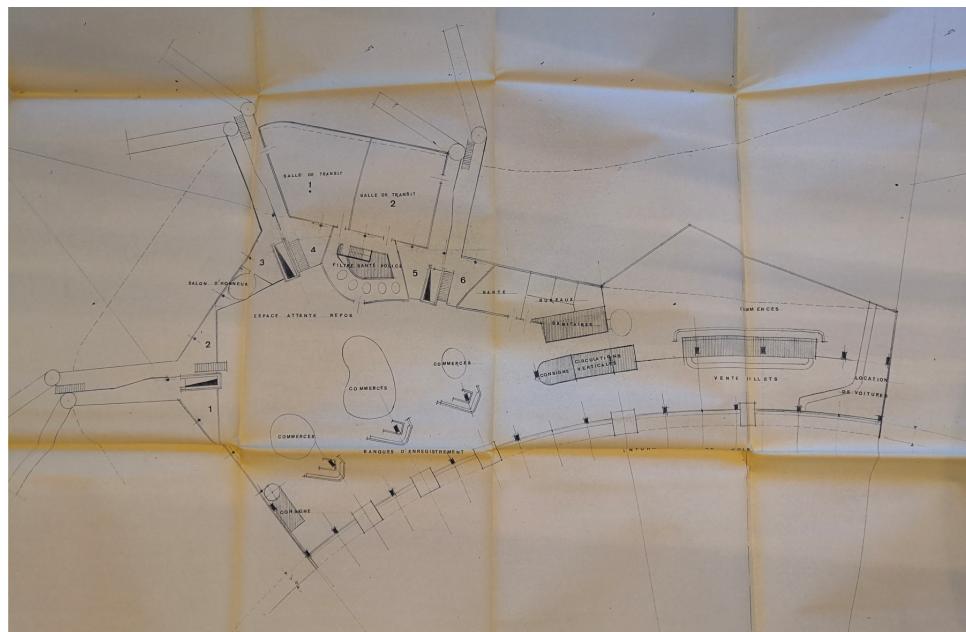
Plan provisoire rez-de-chaussée dit niveau inférieur arrivée, aérogare de Toulouse-Blagnac 2, architectes : Montier, 1972
